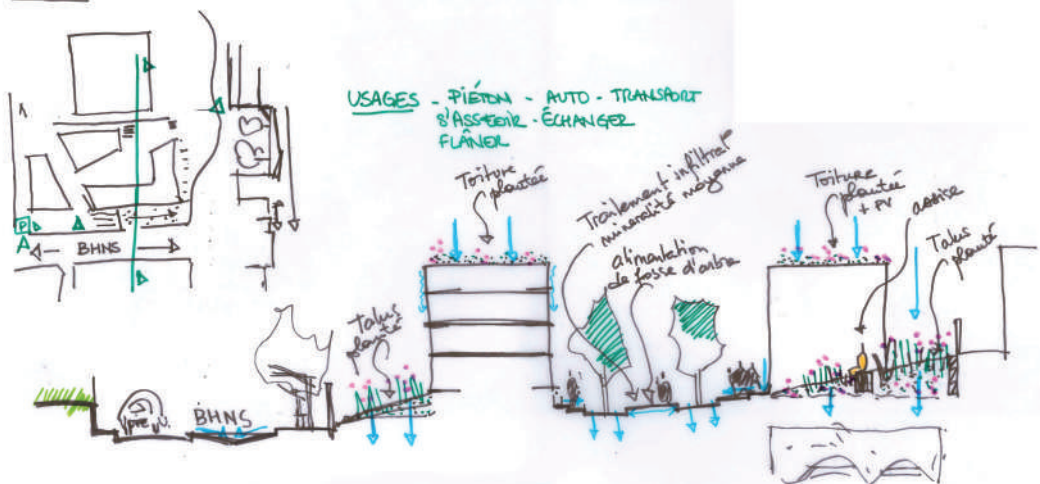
La coupe transversale des architectes paysagistes sur l'îlot universitaire d'Aix-en-Provence
